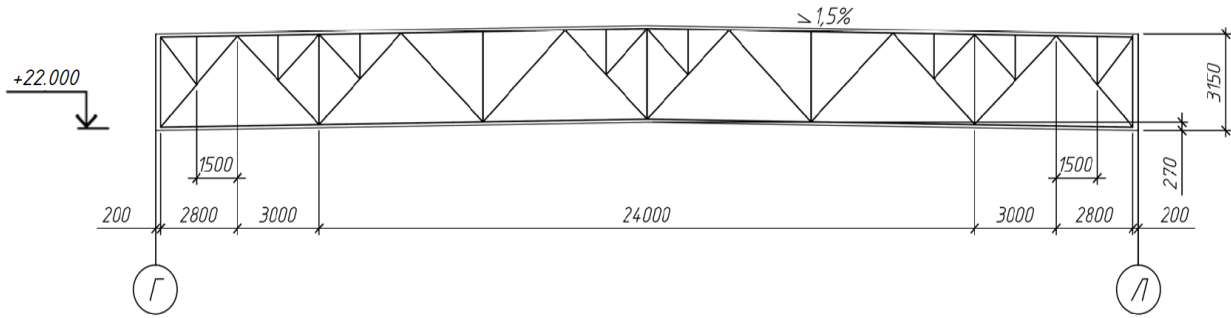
Кроквяні ферми будівлі, що обстежувалась
